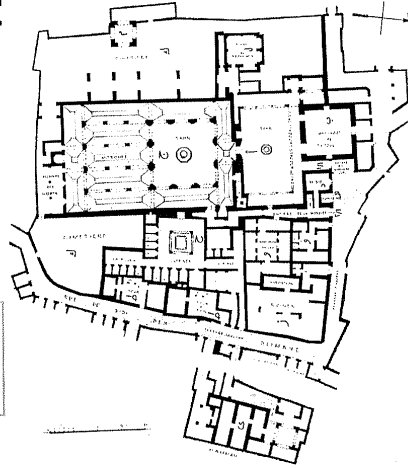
مسقط أفقي لجامع باب دكالة بمراكش.
